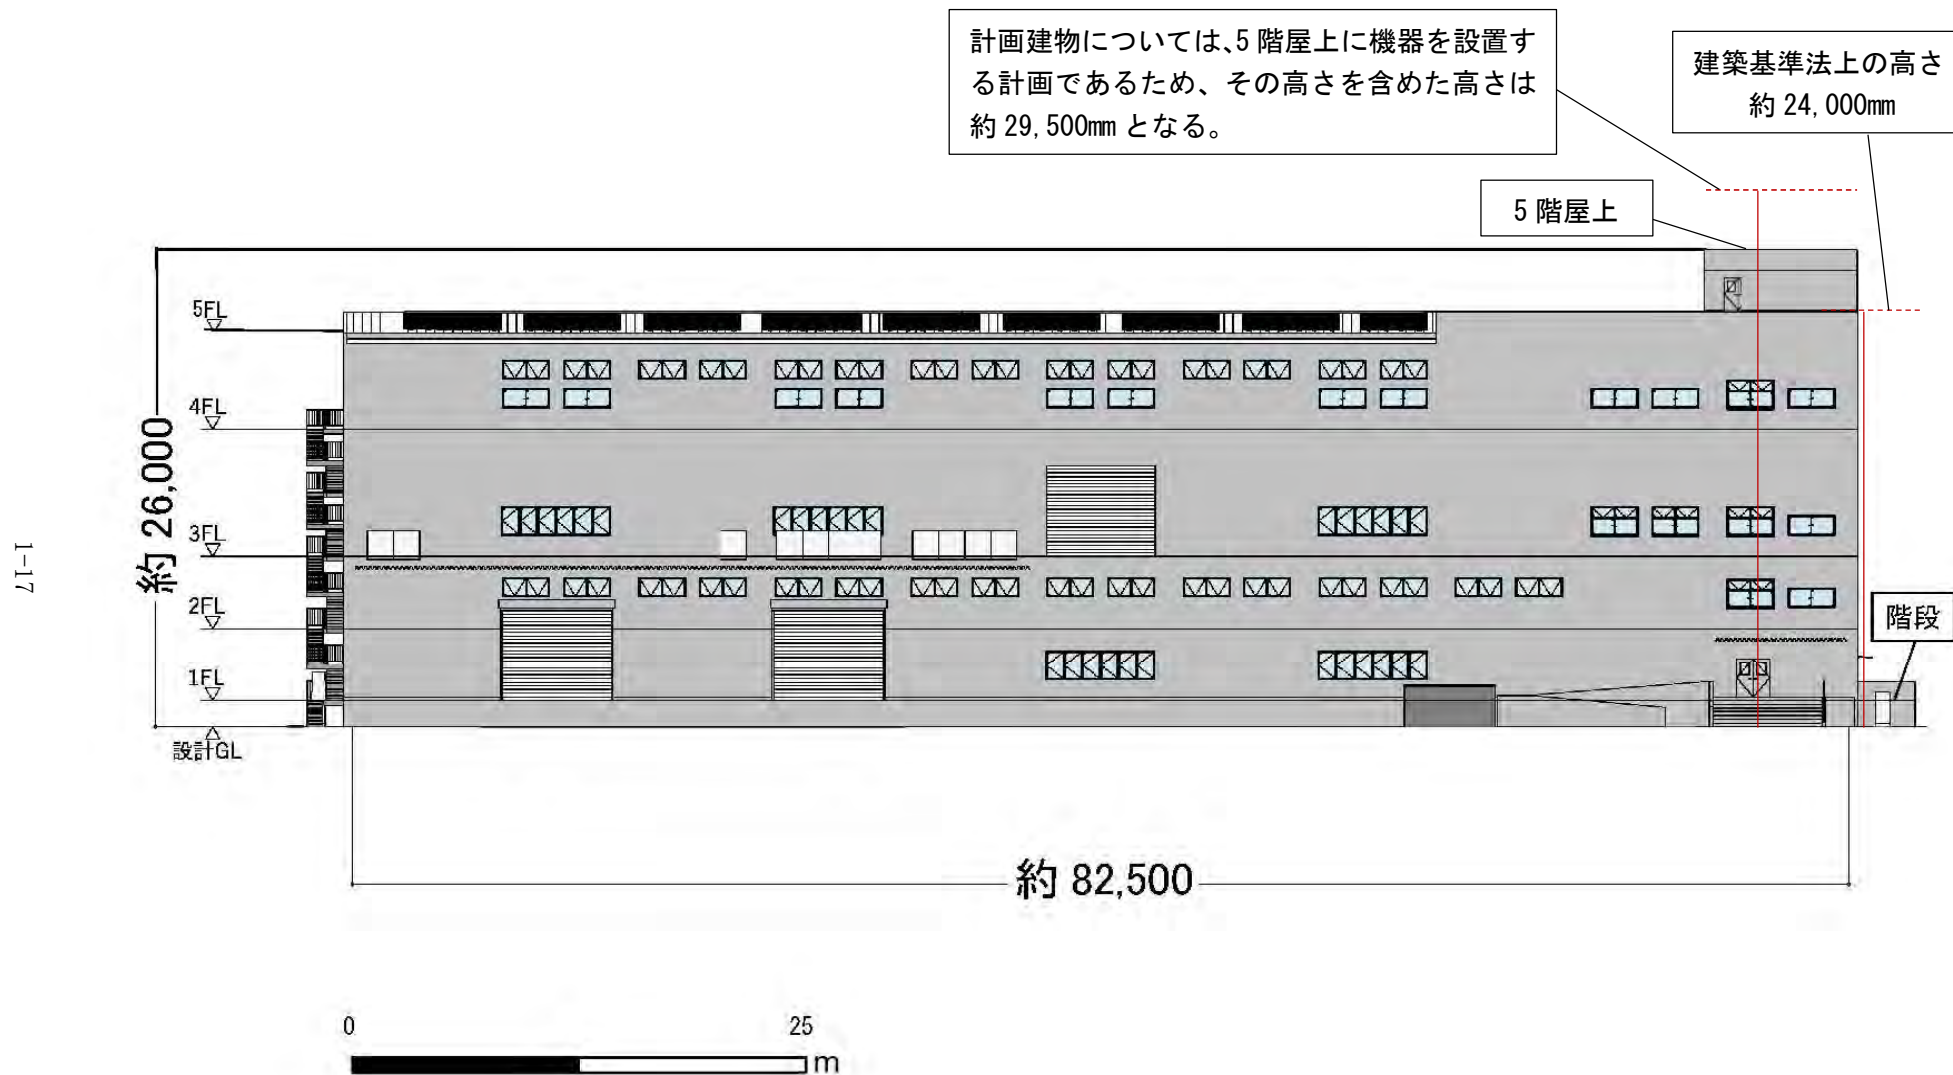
計画建物立面図（西側立面）：単位 mm
